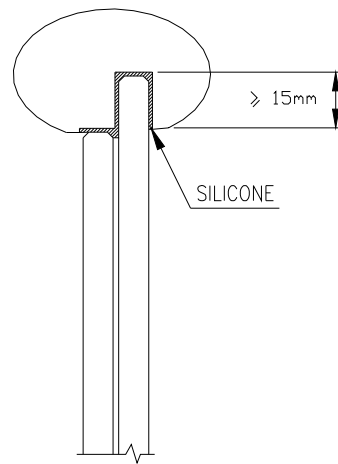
Exemples de Fixation de barre d'appui ou de main courante
